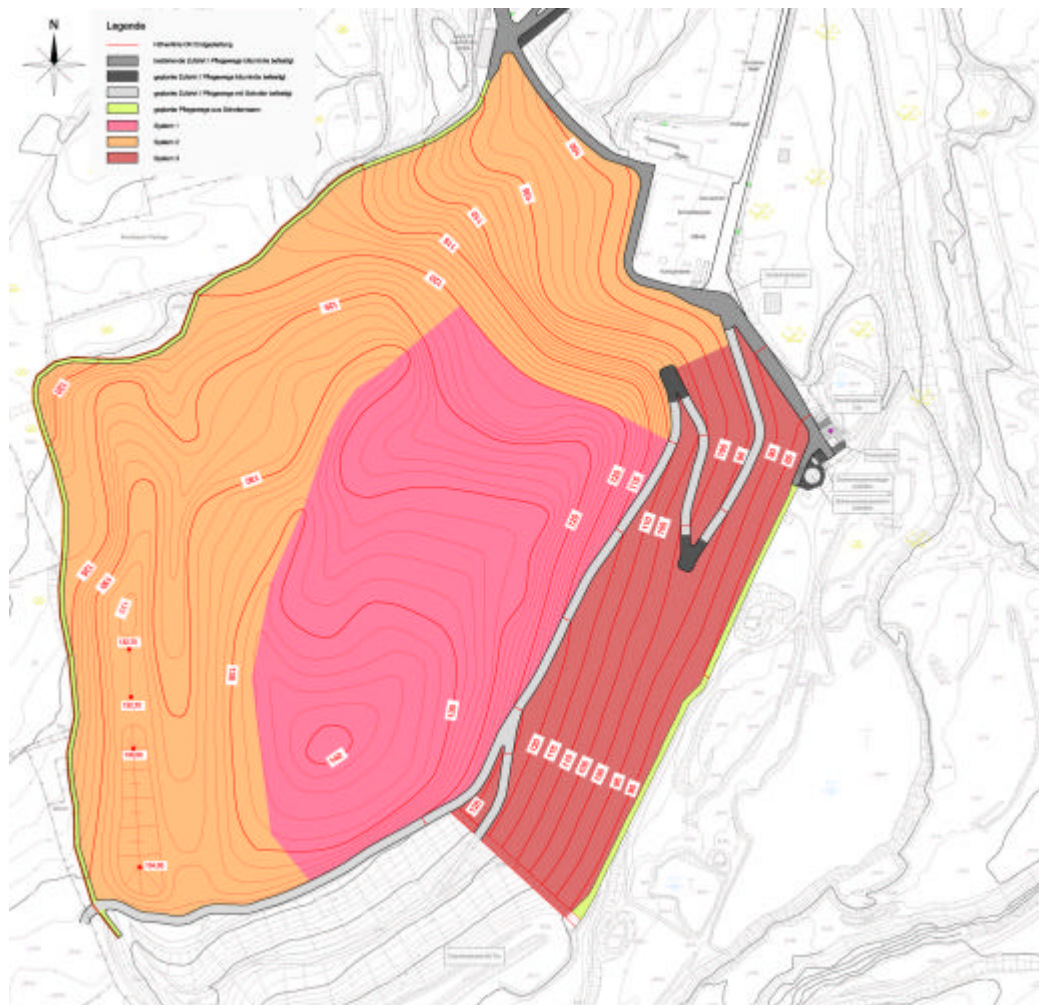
Lageplan Oberflächenabdichtungssysteme
